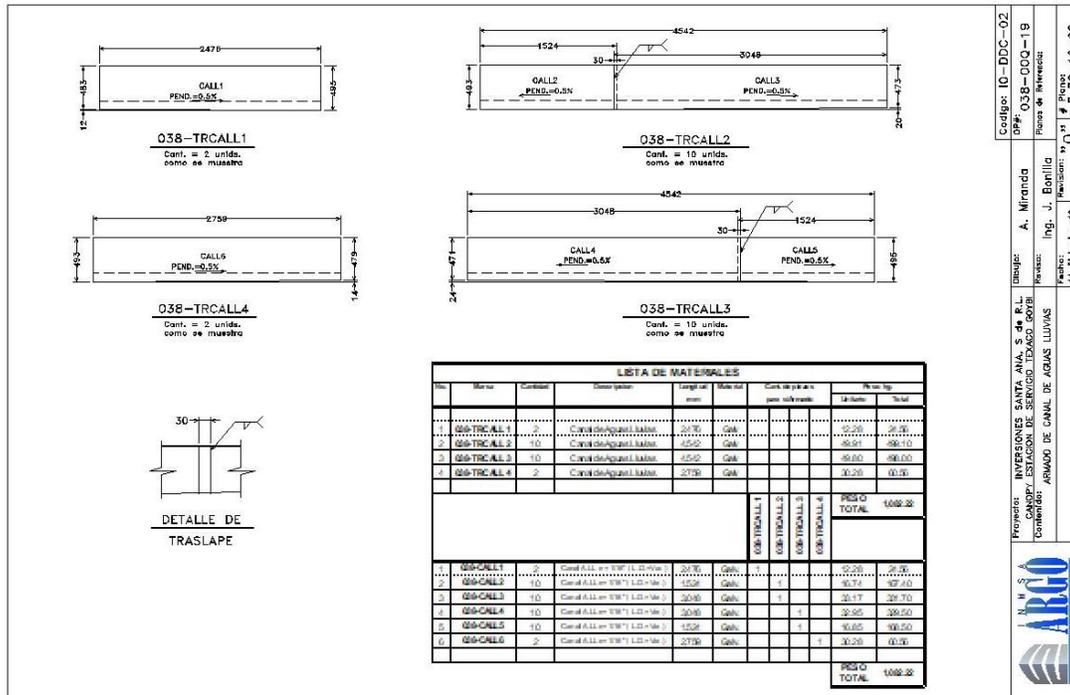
Plano de fabricación de armado de canal aguas lluvias
